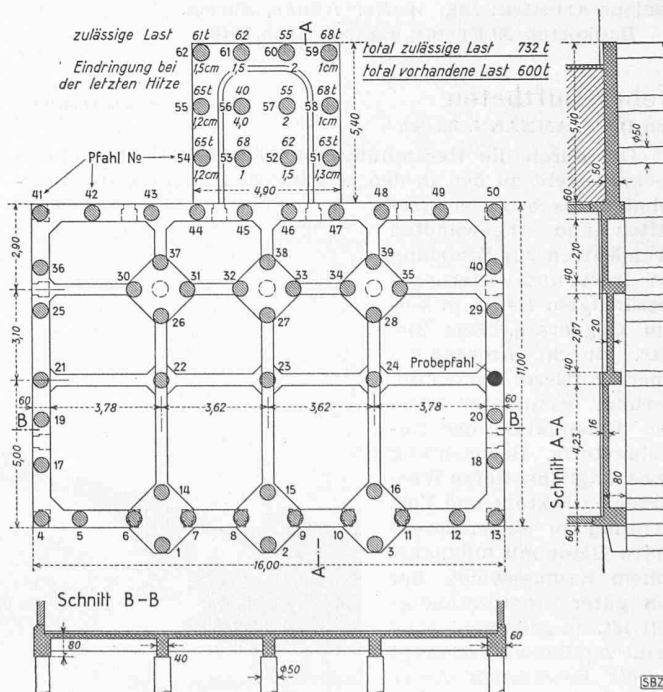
Fundamentplan des Heizturmes, 1 : 250
